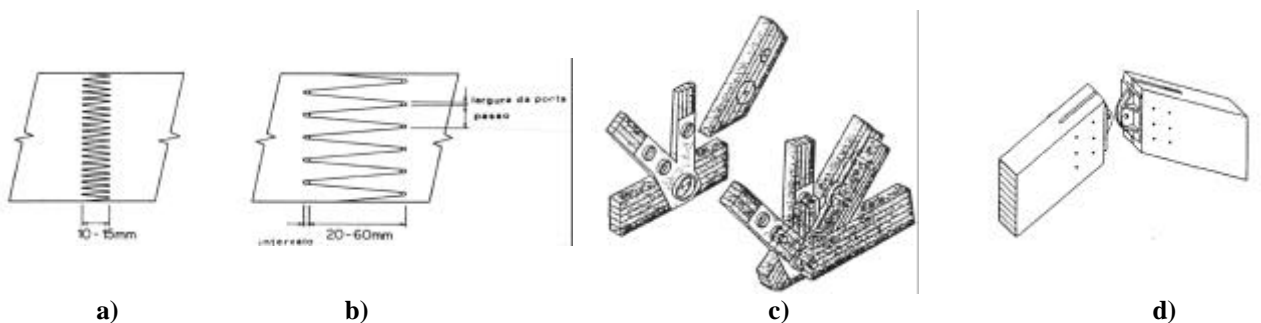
a) Mini “finger joints” para colagem de peças constituintes das lamelas; b) “Finger-joints” para colagem de elementos estruturais; c) Ligação por elementos metálicos e colagem (sem rotação); d) Ligação por rótula
